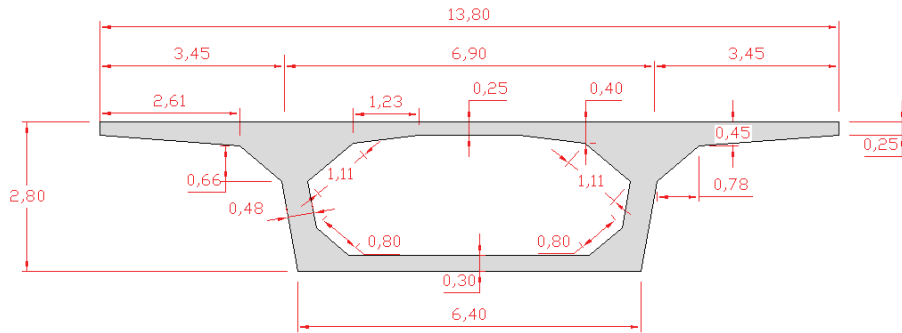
Coupe transversale du voussoir à la clé (VSC)
